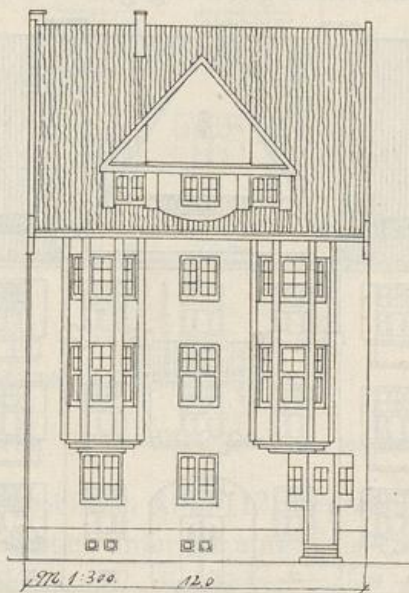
Zwei gleiche Erker entsprechen nicht der Raumaufteilung des Grundrisses. Abb. 44 S. 45.
